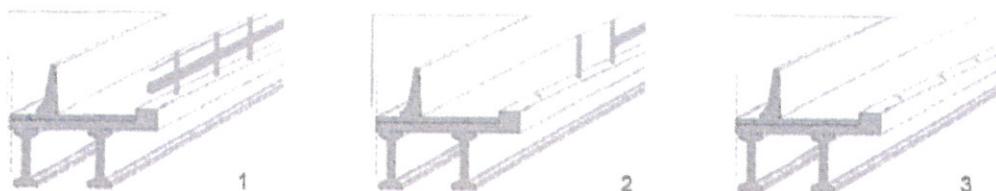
Fasi di montaggio a cantiere protetto di esecuzione del montaggio
